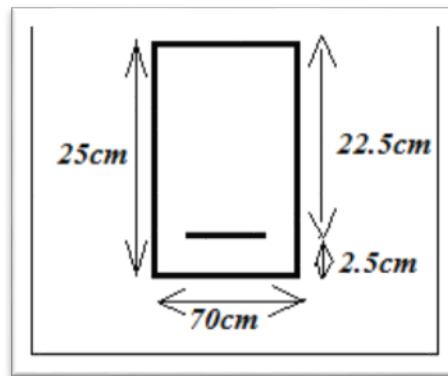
Section théorique pour le ferrailage du plancher (en travée)
